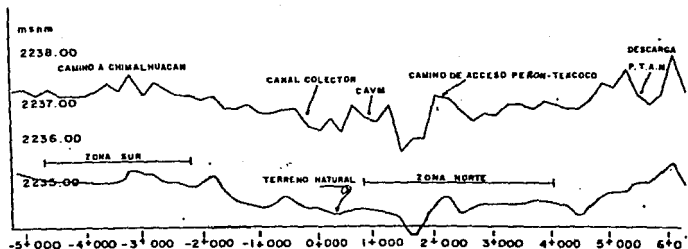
PERFIL DEL BORDO PERIMETRAL AL LAGO NABOR CARRILLO 1983
